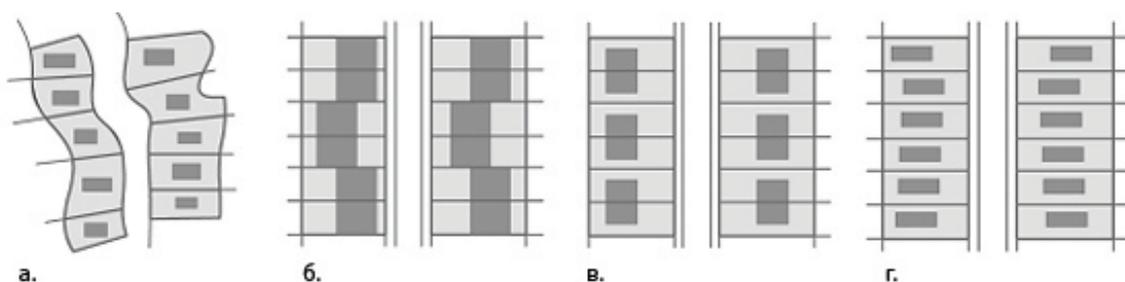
Стиль жилья для отдельных семей: а) дома во дворе; б) рядовые дома; в) двухквартирные дома; г) отдельные дома [19]
